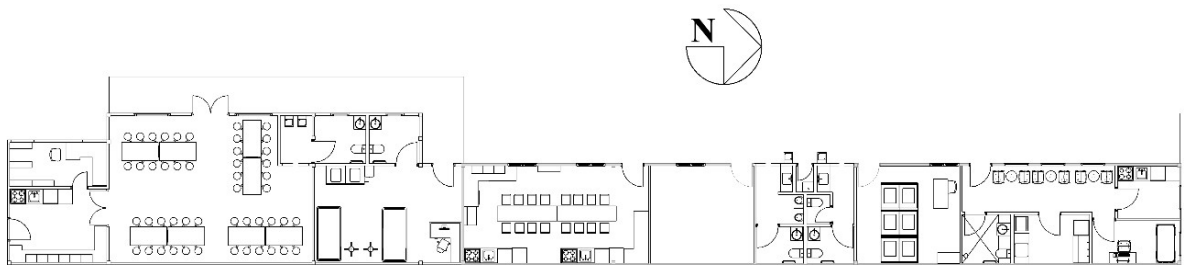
Planta Edificio 3, Zona 1, sin escala.
